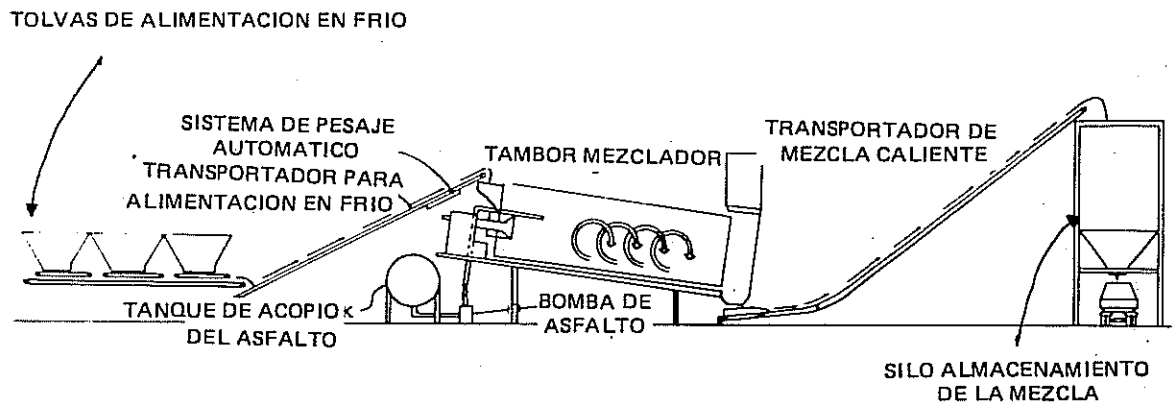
Planta asfáltica de mezclado en tambor (tambor mezclador)
